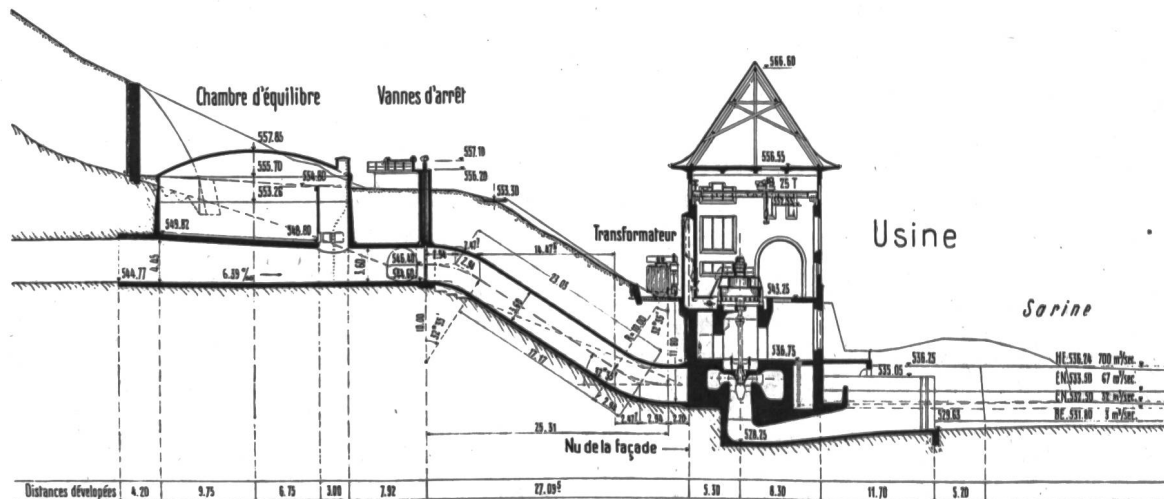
Oelberg. Coupe transversale de l'usine avec conduite forcée et chambre d'équilibre.
